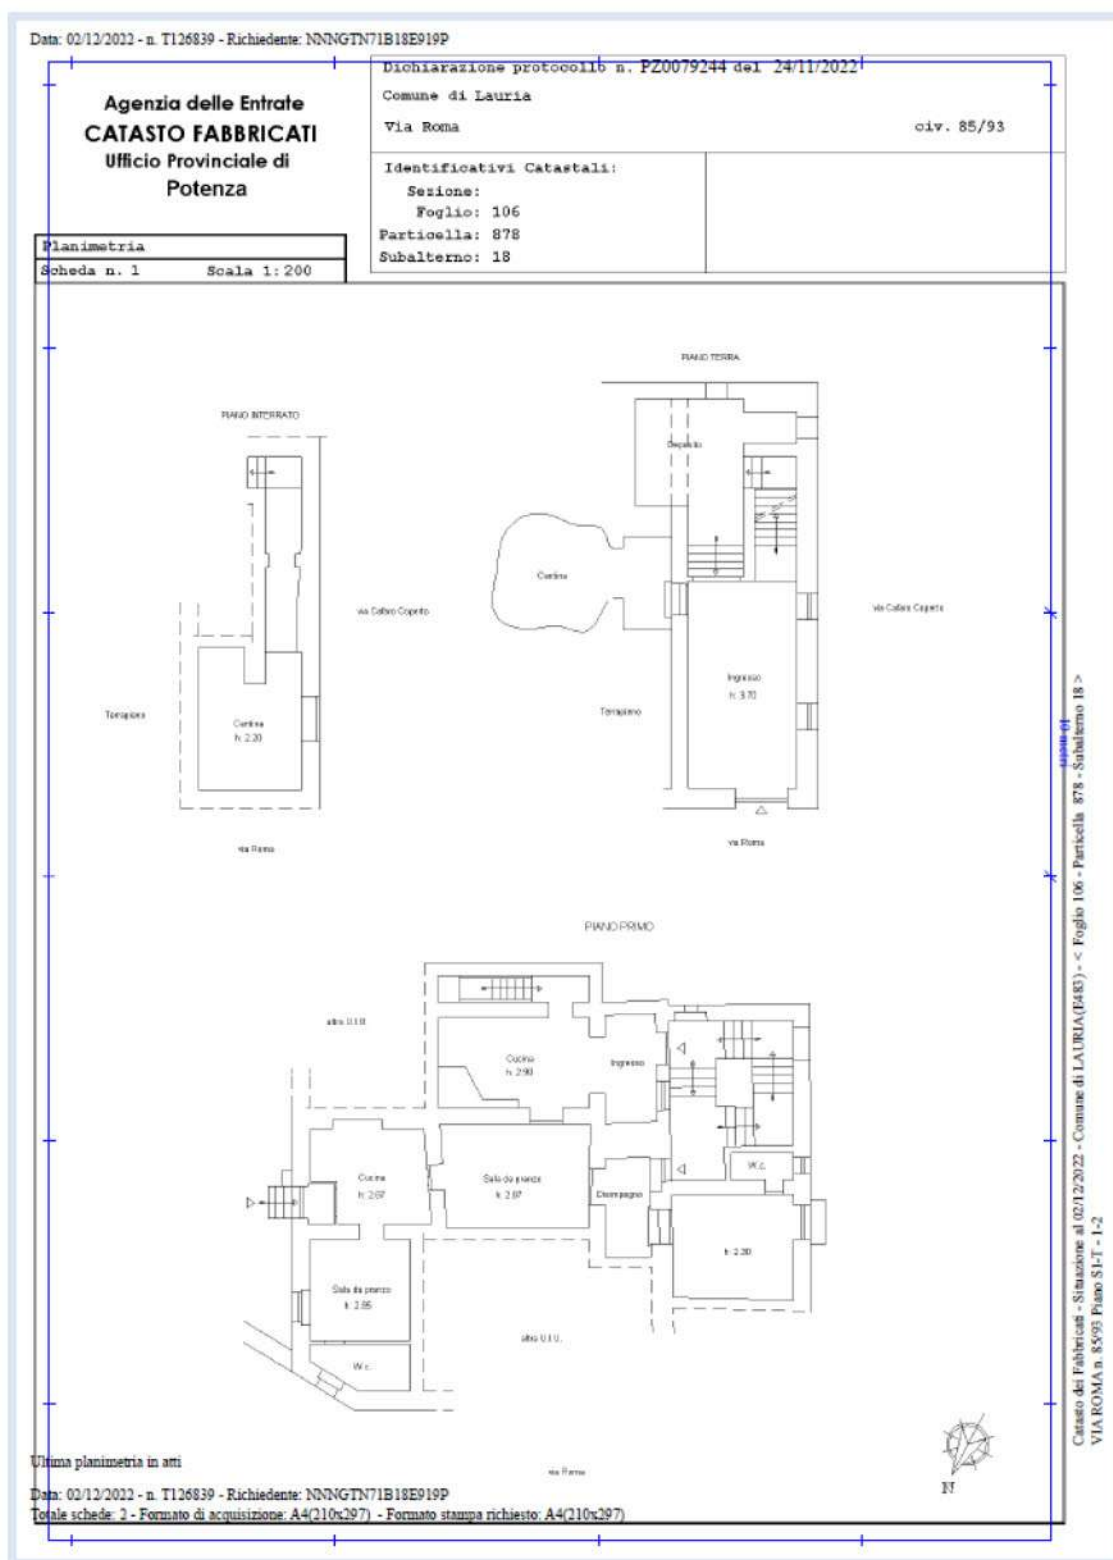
Planimetria “aggiornata” Unità Fig. 106 P.IIIa 878 sub. 18
